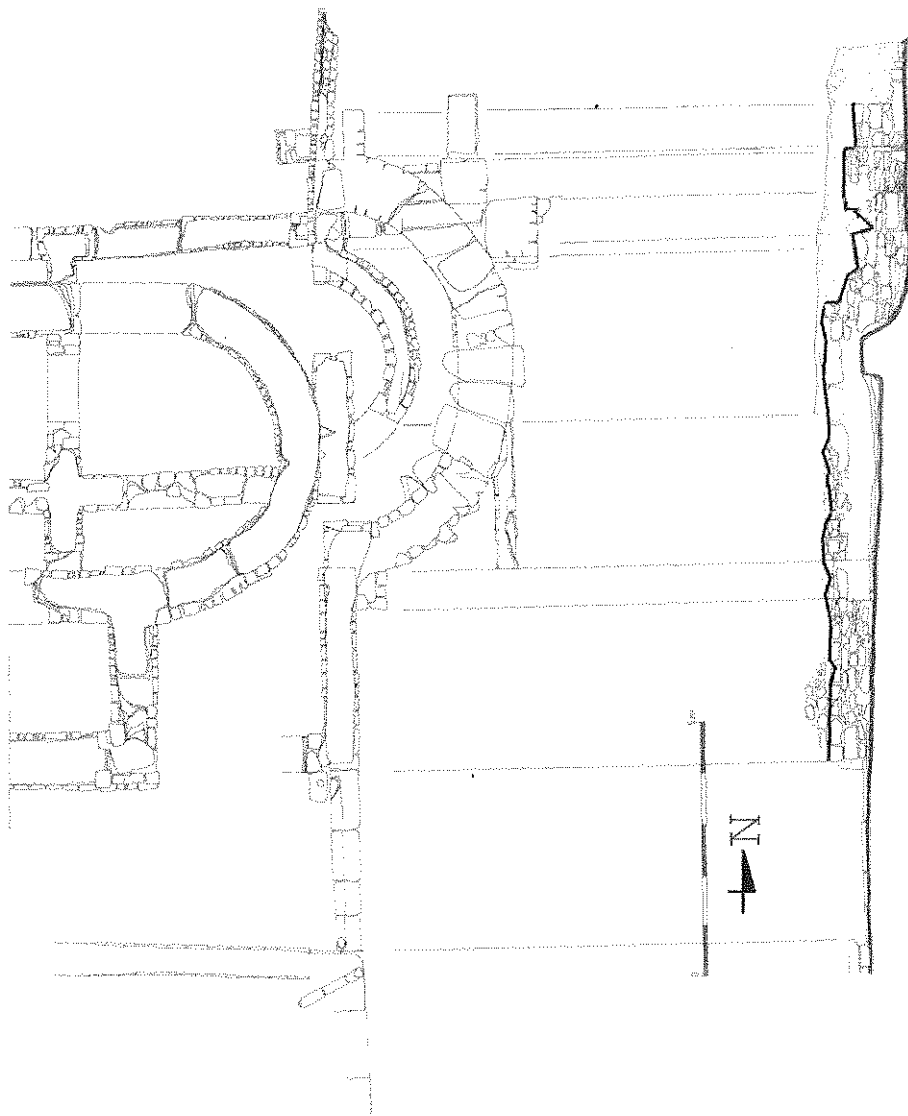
Nowe — secteur X. Plan des basiliques du St. Medeksa
